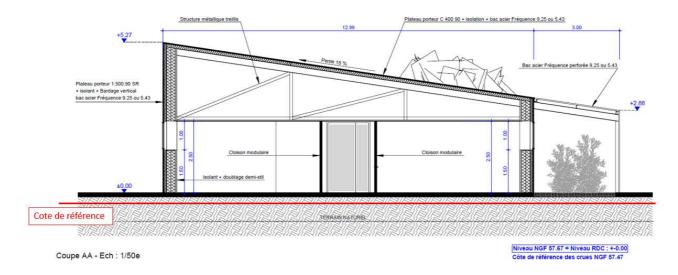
Façade des bureaux - Coupe AA (source : J. Lacombe, 05/11/18)
